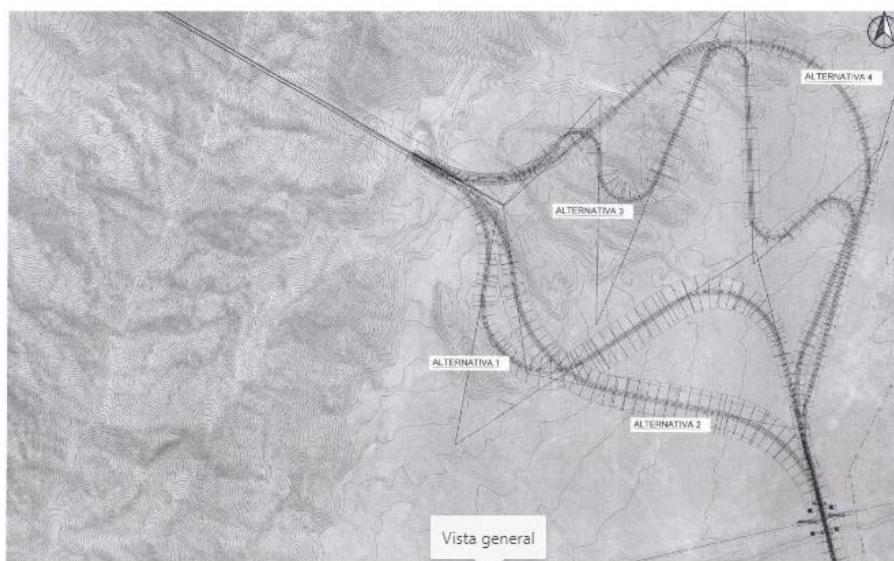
Vista en planta del trazado previsto para el proyecto bajo estudio, destacando la posición del túnel a través de la sierra de Marquesado
